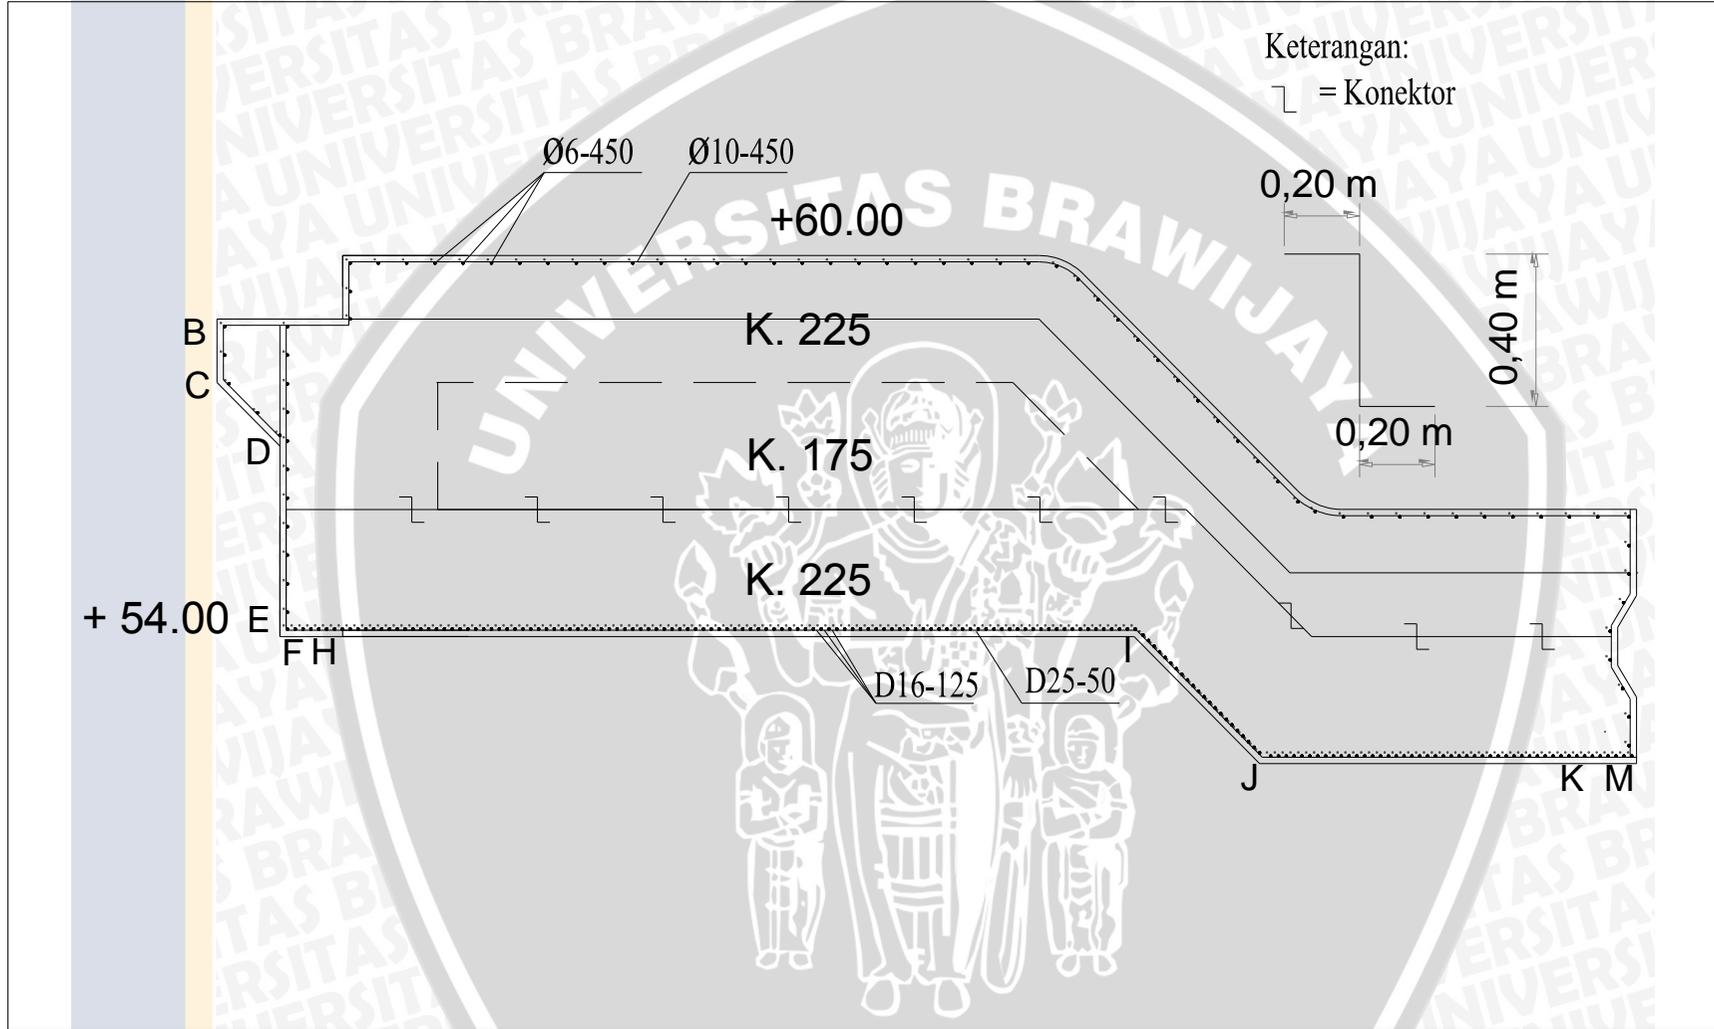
Sambungan Konstruksi Pada Bendung Gerak
